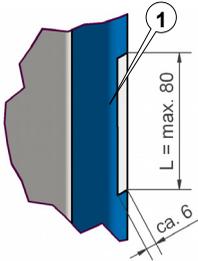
Blanke Stelle an der (Eck-)Zarge für Schweißmontage (Beispiel)
